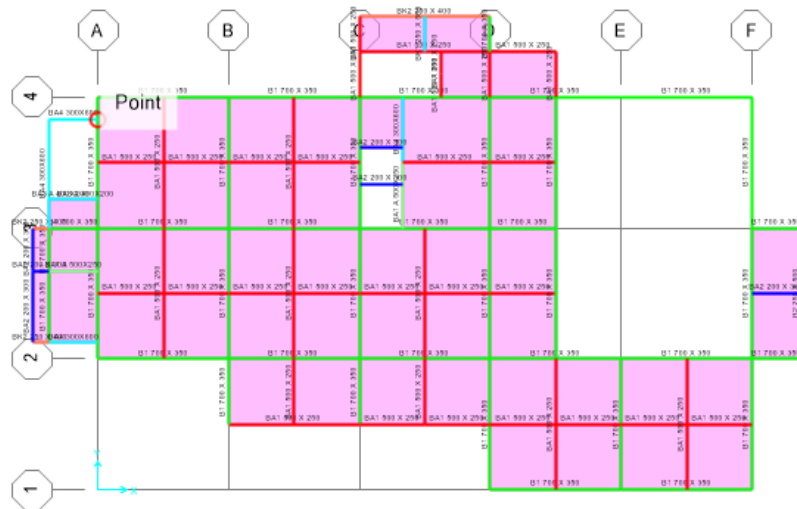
19 Permodelan Balok dan Pelat Lantai 4
